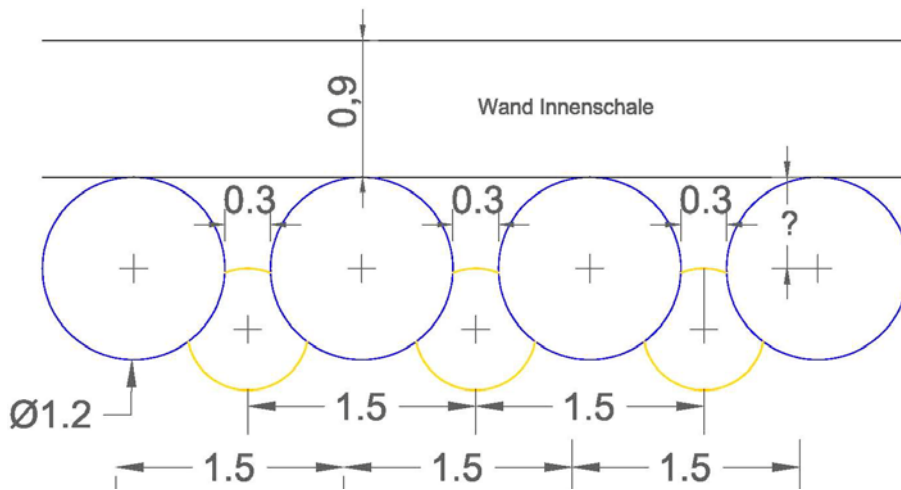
Darstellung der Bohrpfähle und der aufgehenden Innenschalenwand im Grundriss
